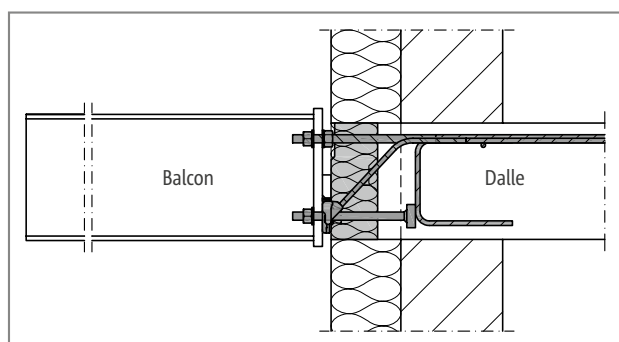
Schöck Isokorb® T type SK : Grâce à la saillie du plancher, l'extérieur du corps isolant affleure l'isolation du mur, tout en tenant compte des distances par rapport aux bords latéraux
